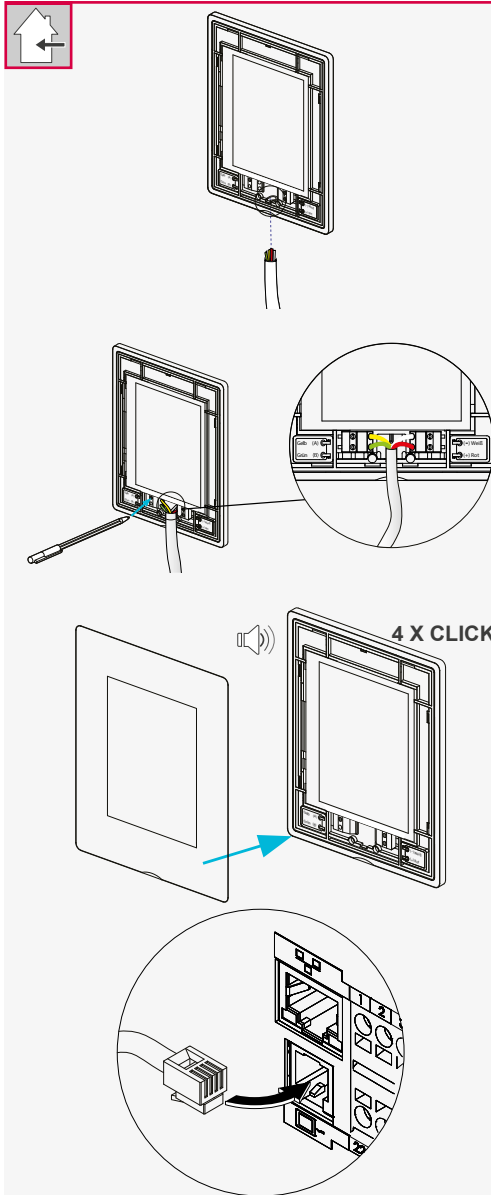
Anschlussplan Bedienpanel mit RJ9-Stecker.
